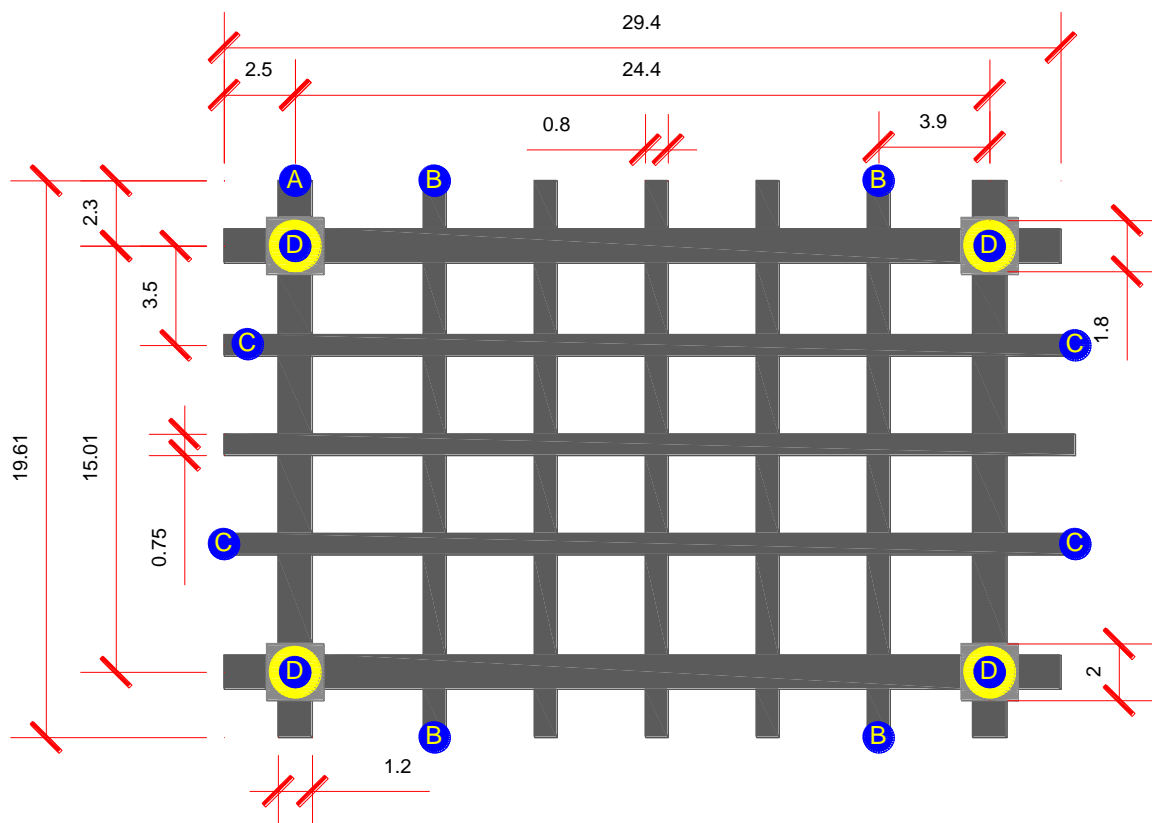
Planta de la cimentación del distribuidor San Antonio.
